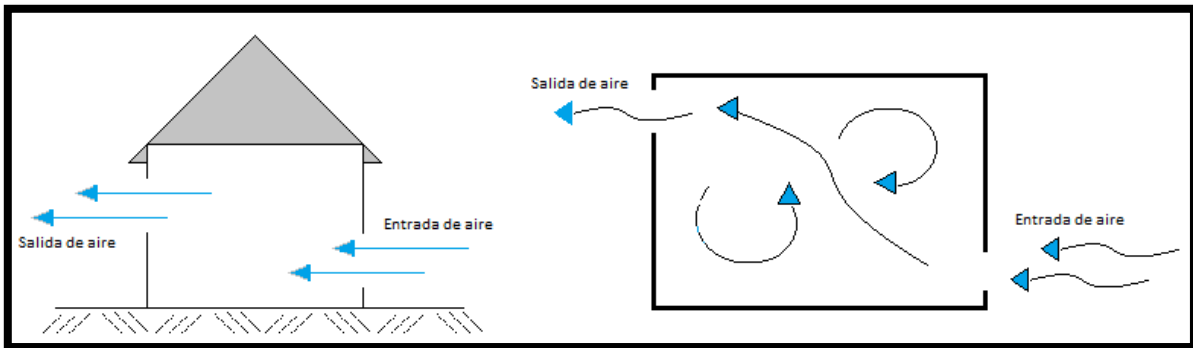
Esquema de ventilación cruzada en elevación y planta.
